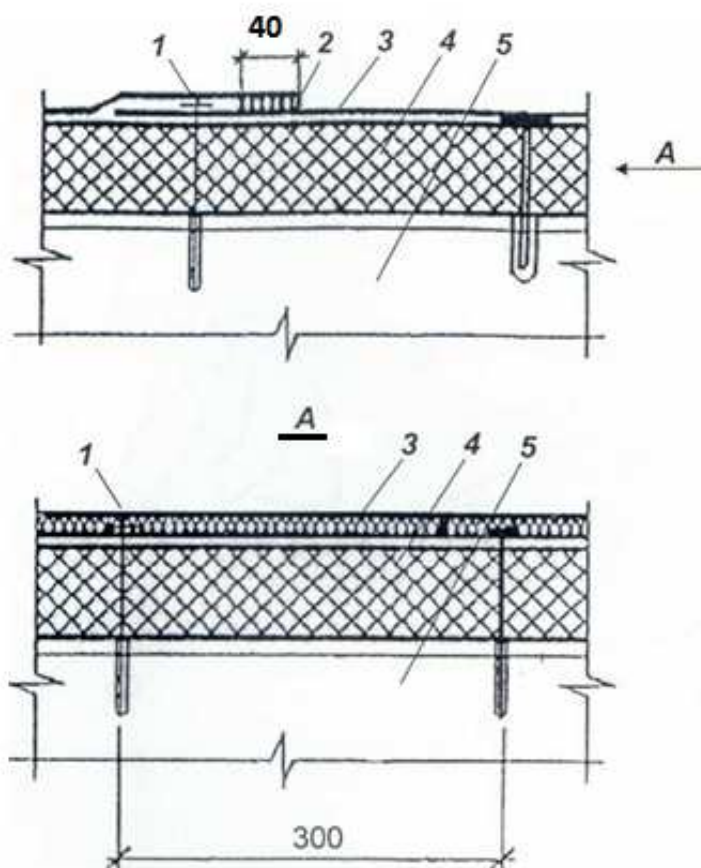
Схема крепления гидроизоляционного ковра из полимерных мембран и утеплителя к бетонному основанию
